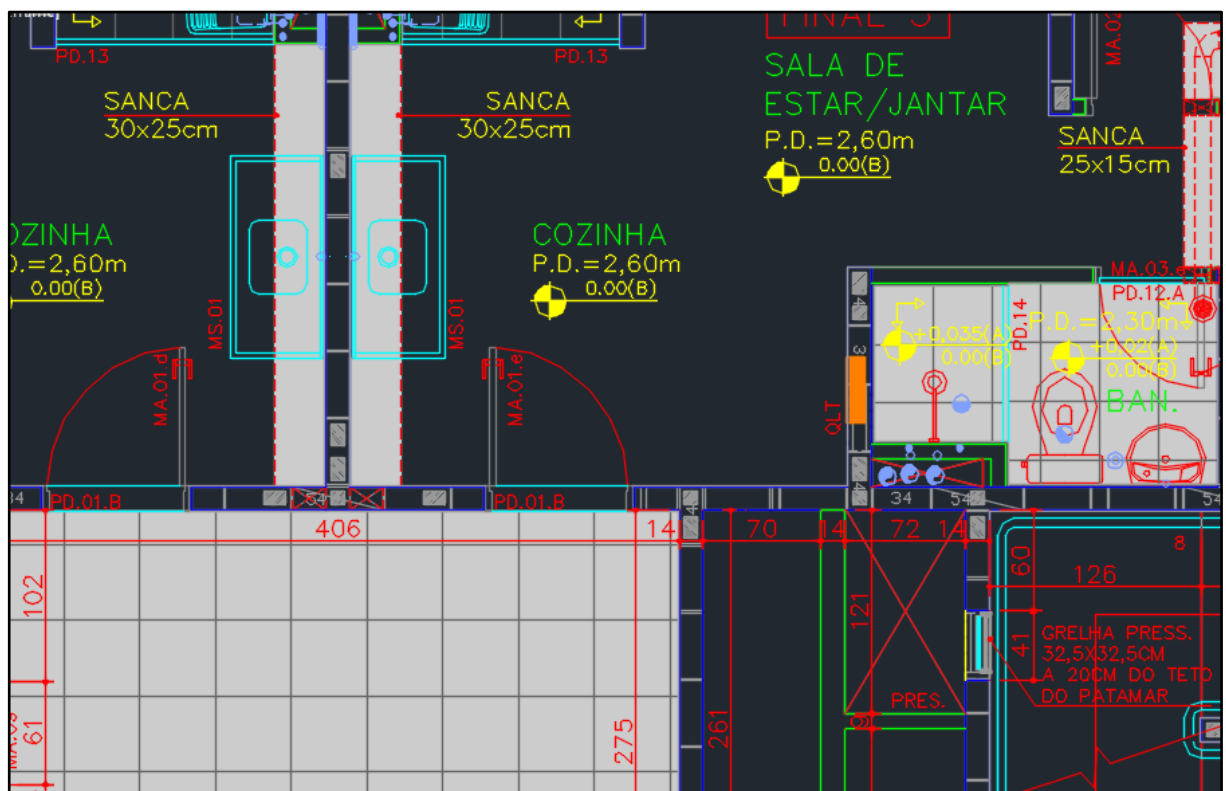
Projeto arquitetônico do primeiro pavimento (fonte: empreendimento estudo de caso)
